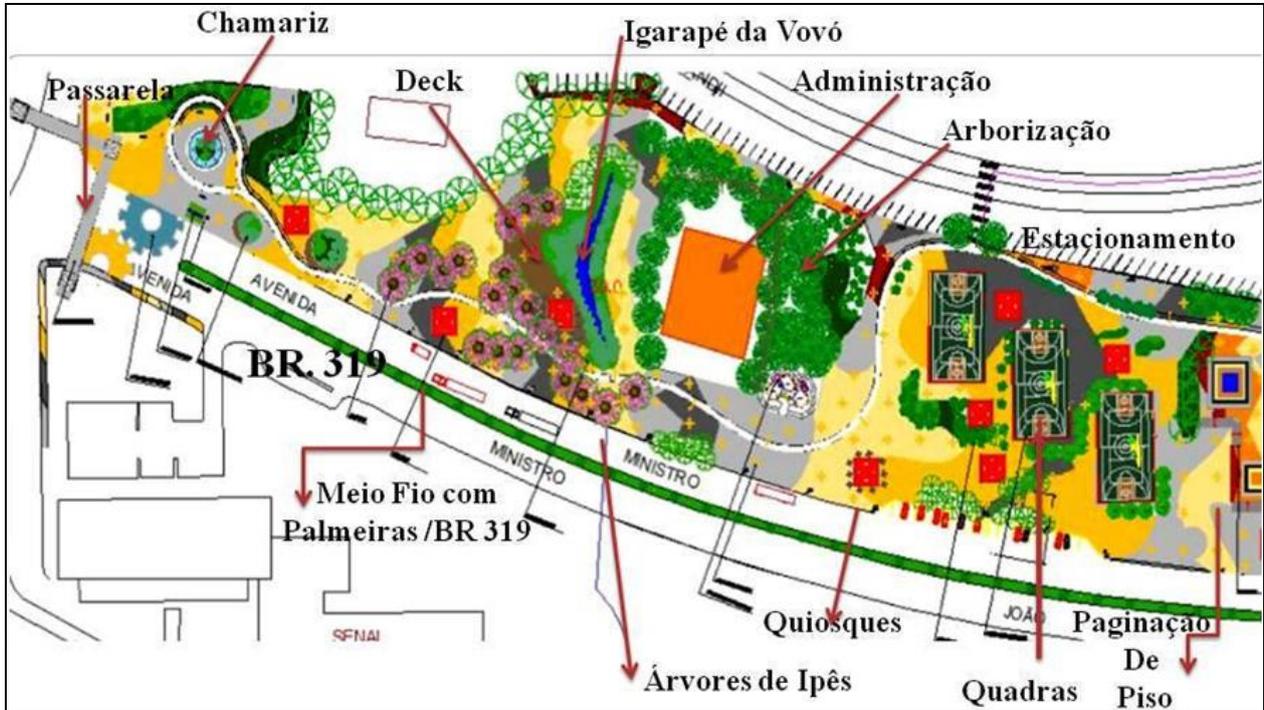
Planta de layout do início do Calçadão da SUFRAMA (trecho 01).
